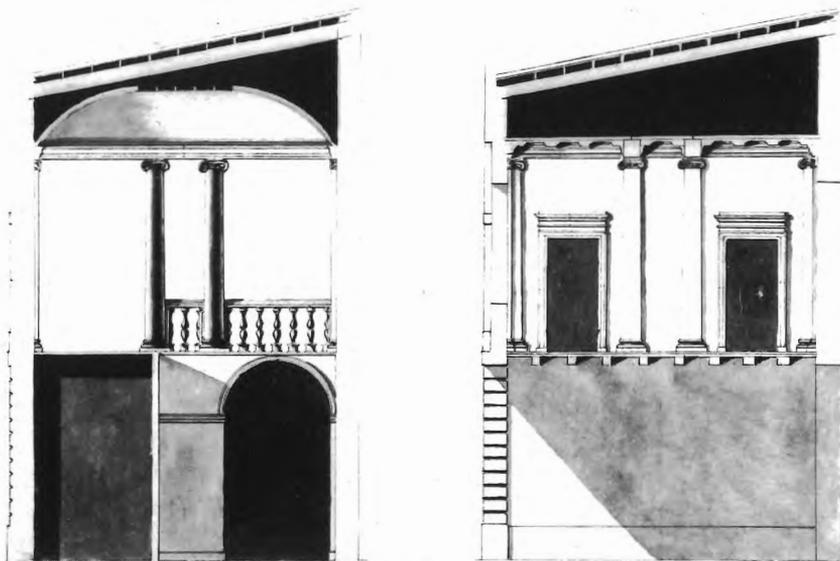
Progetto di realizzazione dello scalone di accesso alla Sala Lapidaria promosso dall'arcivescovo Chiarissimo Falconieri nel 1838. Prospetto parete sud (BSF, Fondo Piancastelli, Carte Romagna, busta 223).
